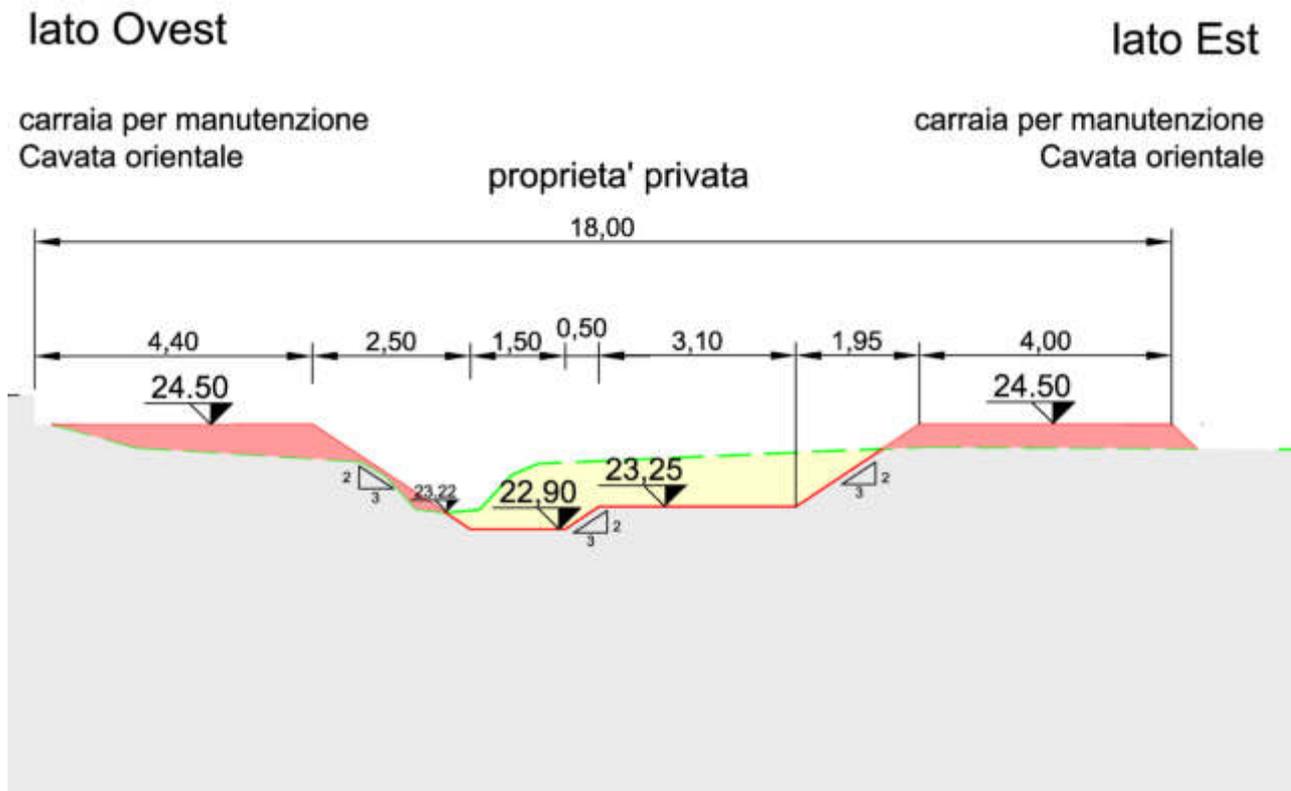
Sezione tipologica di progetto relativa al tratto 1. La linea verde indica la sezione rilevata nello stato attuale, quella rossa la sezione di progetto, mentre l'area gialle indica la sezione di sbancamento e quella rossa la sezione di riporto.
